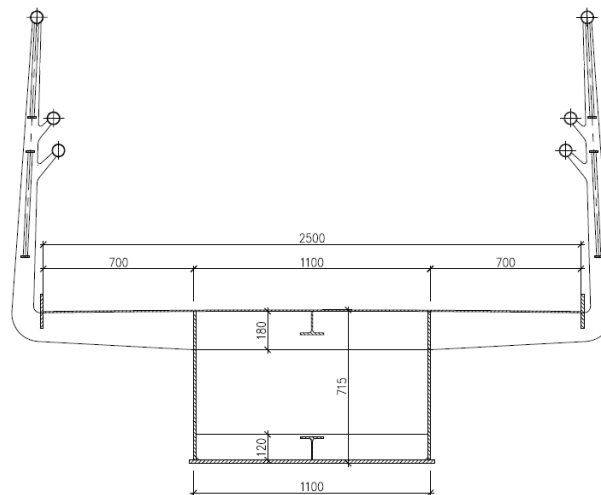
Secção transversal da concepção com viga caixão [24].
